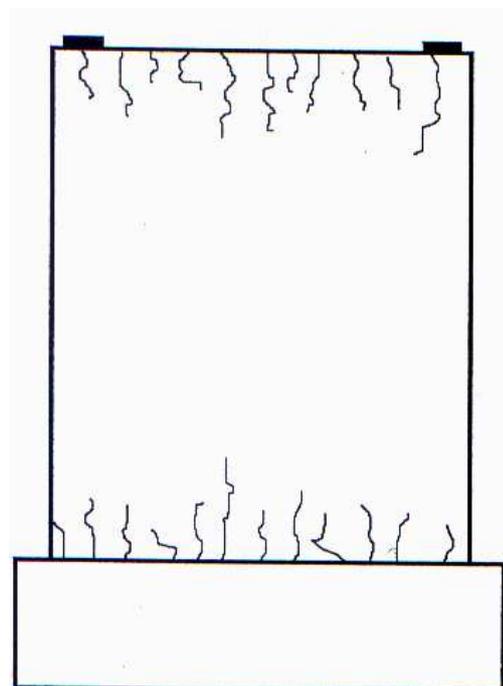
Possíveis configurações de fissuras em pilares e pontes de concreto
